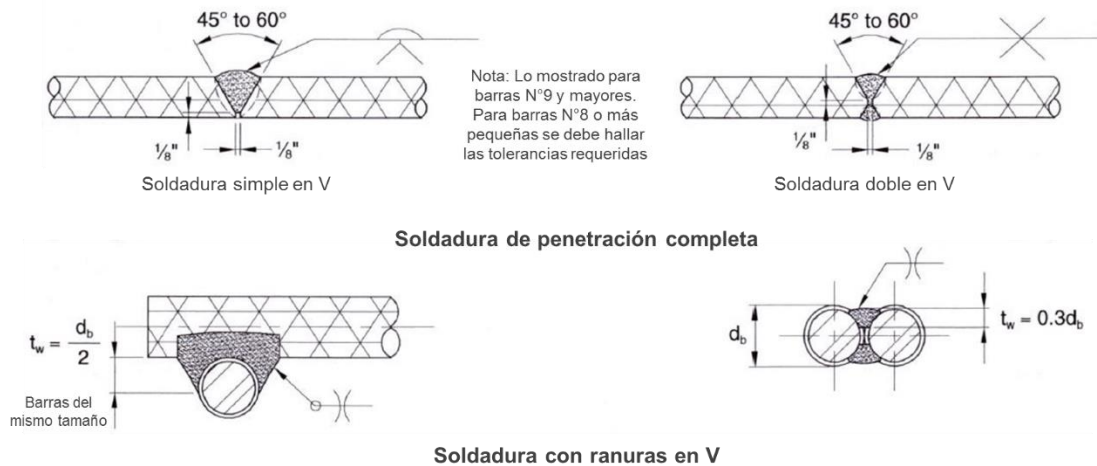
Principales tipos de soldadura para conexiones. Adaptado de (BCA, 2001)
